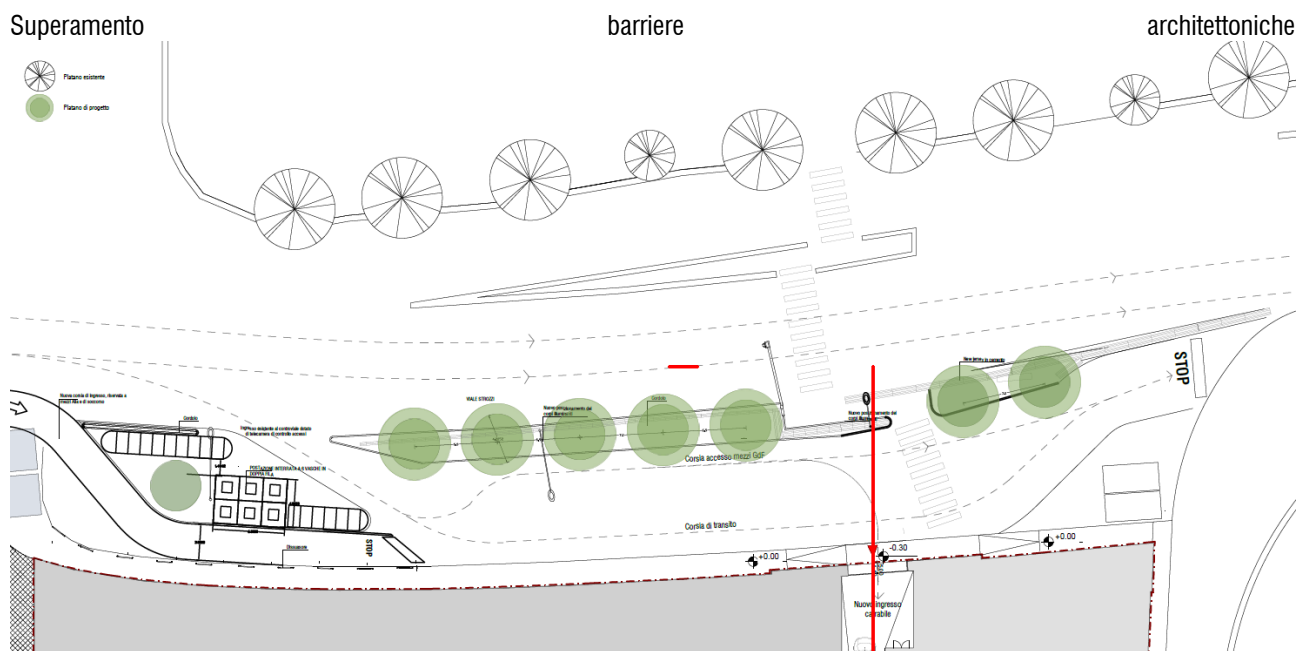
schema planimetrico dell'area a parcheggio su viale Strozzi
